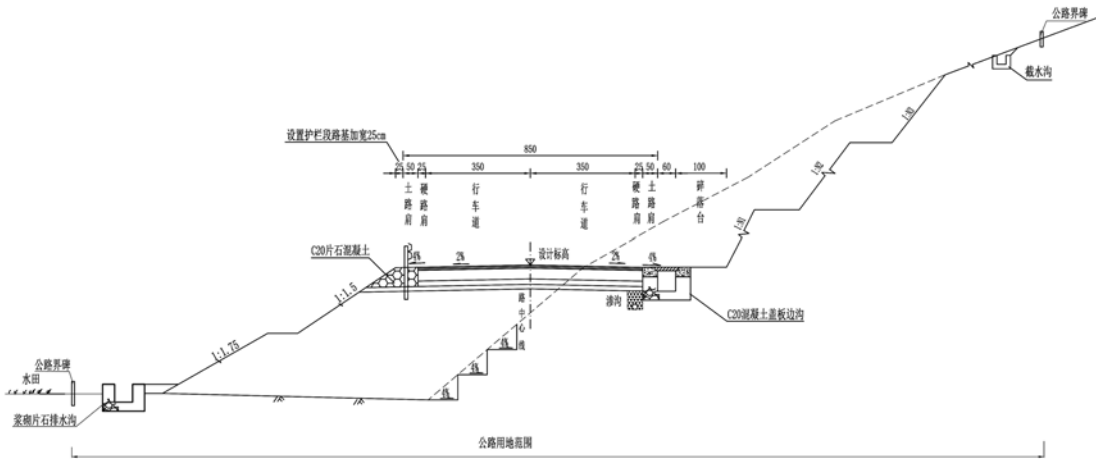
8.5 m 宽路基标准横断面图（尺寸单位：cm）
